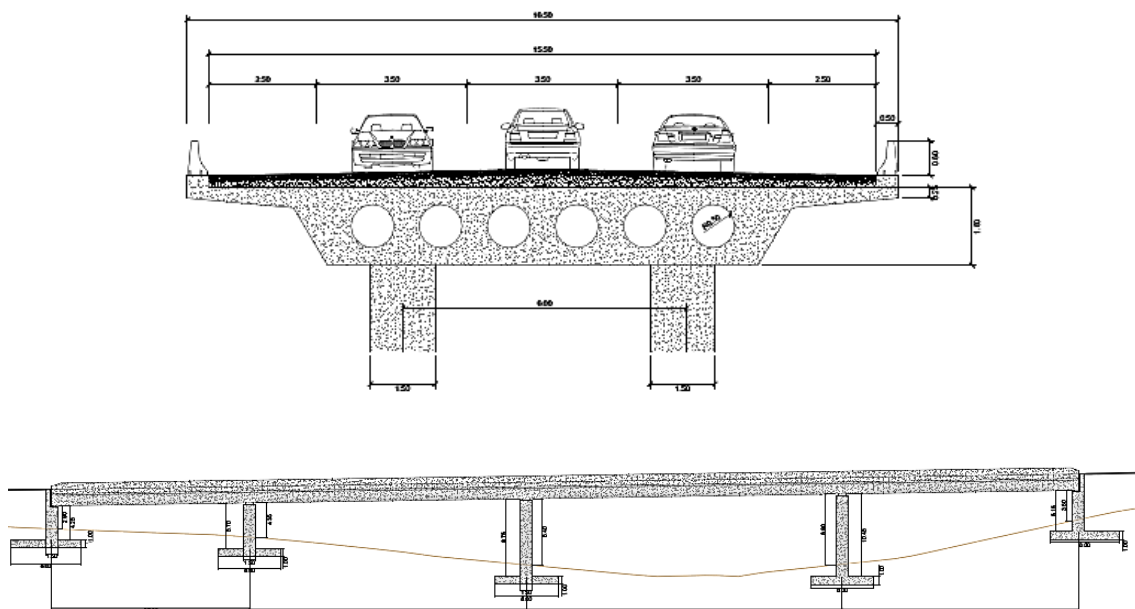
Sección tipo y sección longitudinal del Puente 3
